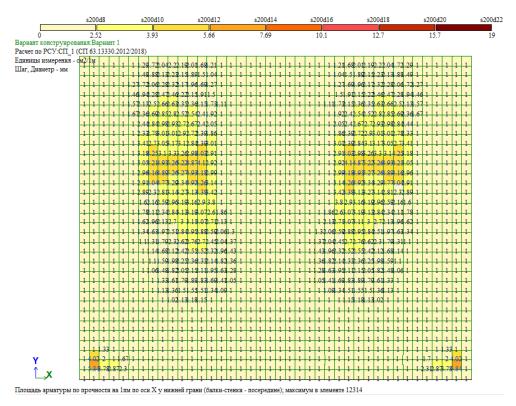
Требуемое нижнее армирование перекрытия по X, после усиления односторонним наращиванием
